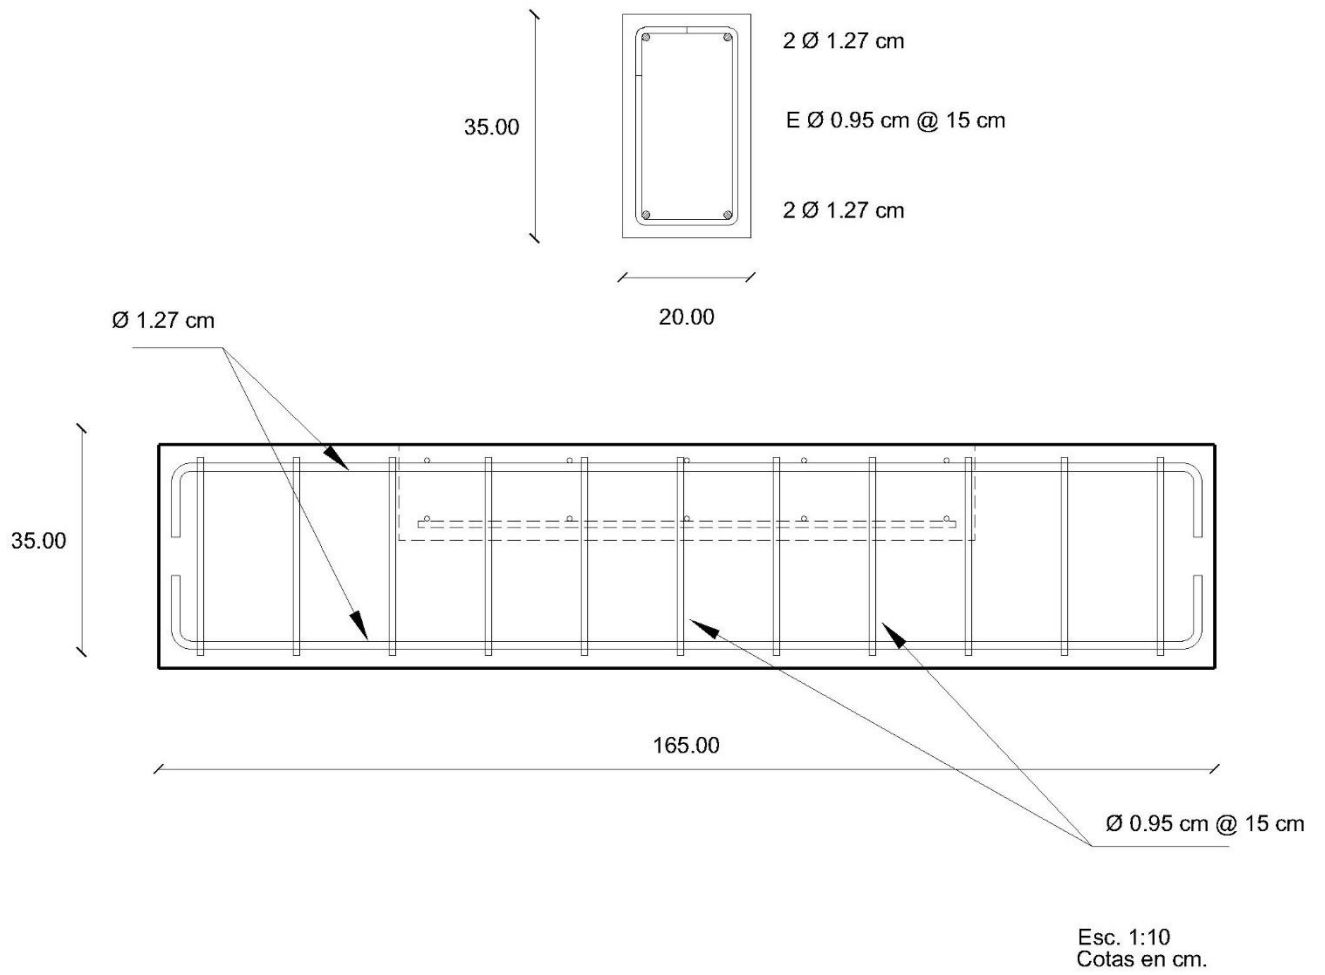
Detalles de la losa de reacción móvil (corte C-C' y D-D').
